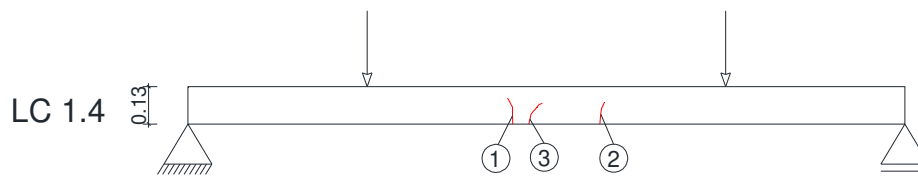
Ilustração da fissuração e posição relativa das fissuras da laje LC 1.4 ($h_t = 13$ cm)
